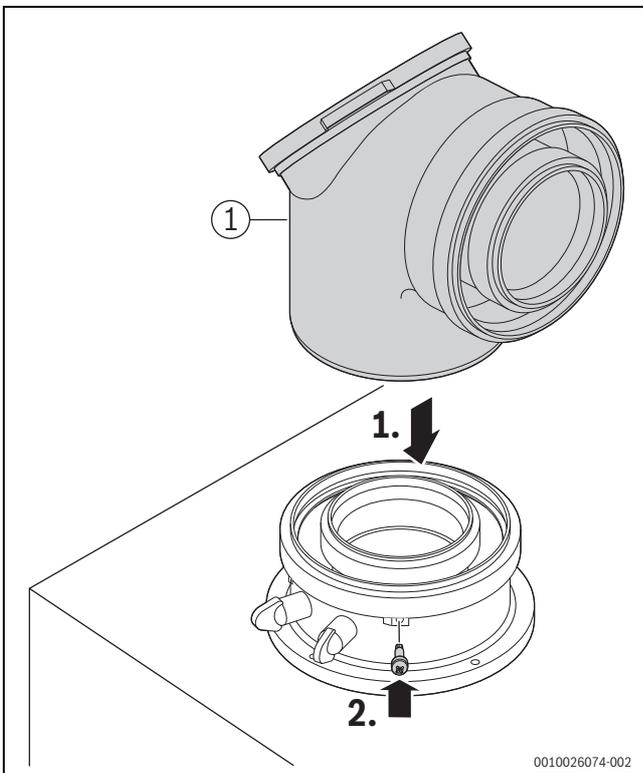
Abgaszubehör einsetzen und mit Schraube sichern
